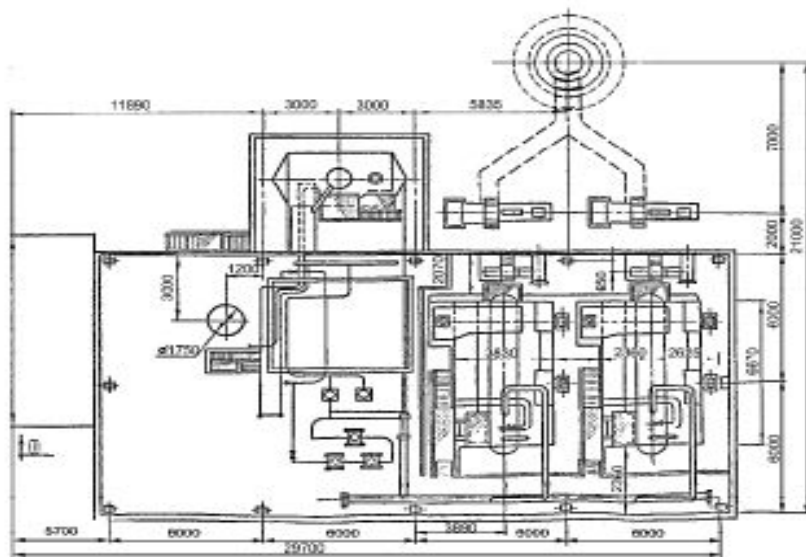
План котельной с двумя котлами ДКВР-4-13
